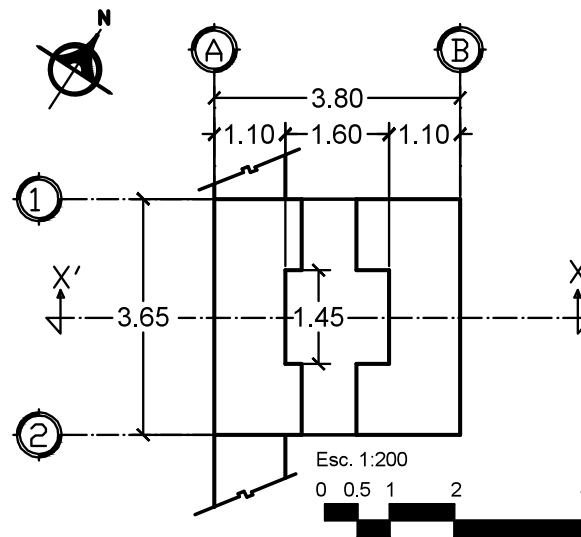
Planta Arquitectónica chacuaco Cuahuixtla
